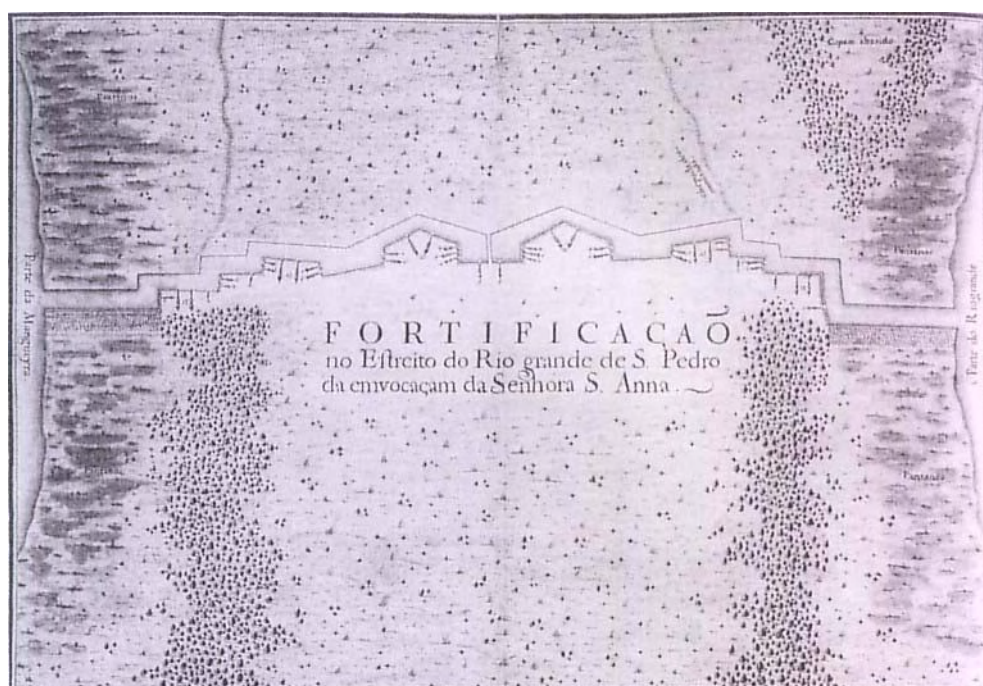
Planta 2 - Fortificação Santa Ana do Estreito¹⁸⁸
